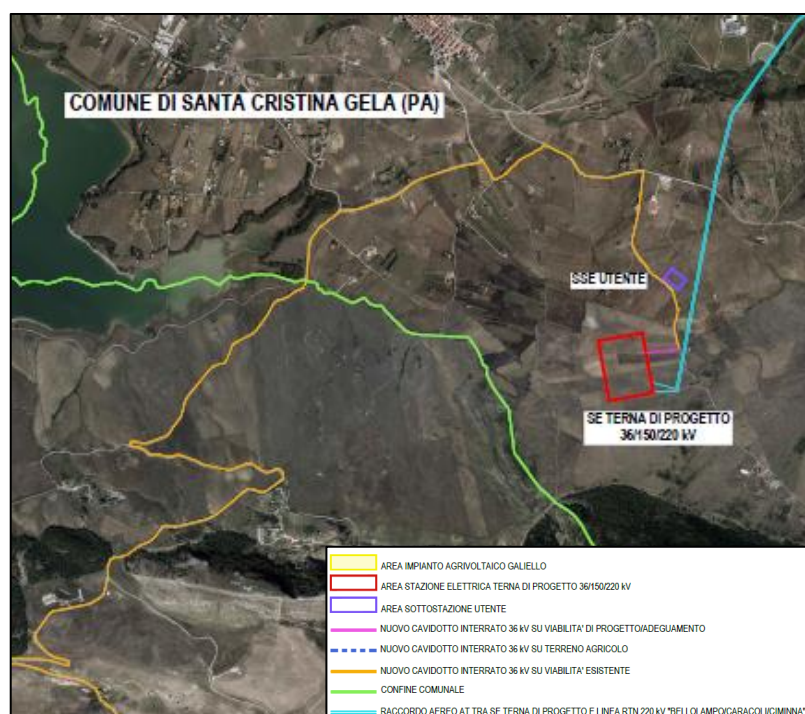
Inquadramento opere di progetto (aree stazioni) su Ortofoto (Scala 1:10.000)
